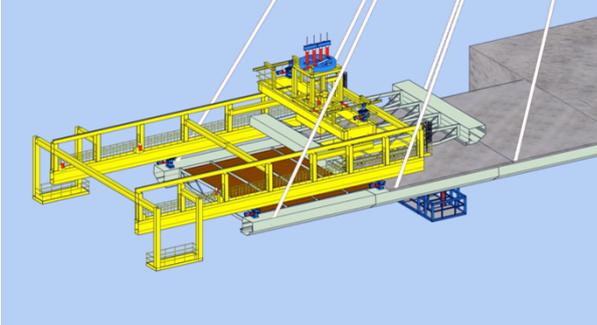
Equipo para lanzamiento de tramos metálicos de tablero
